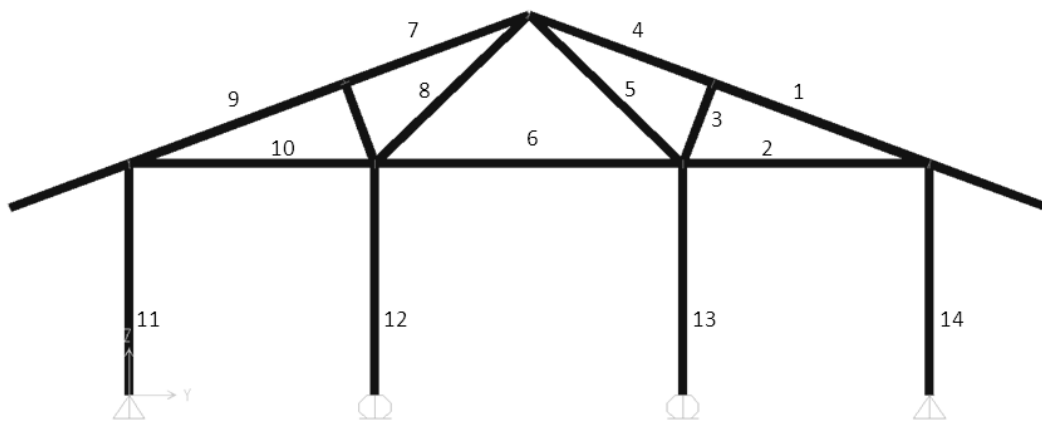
Numeração das barras no plano y-z (Pórtico plano)
